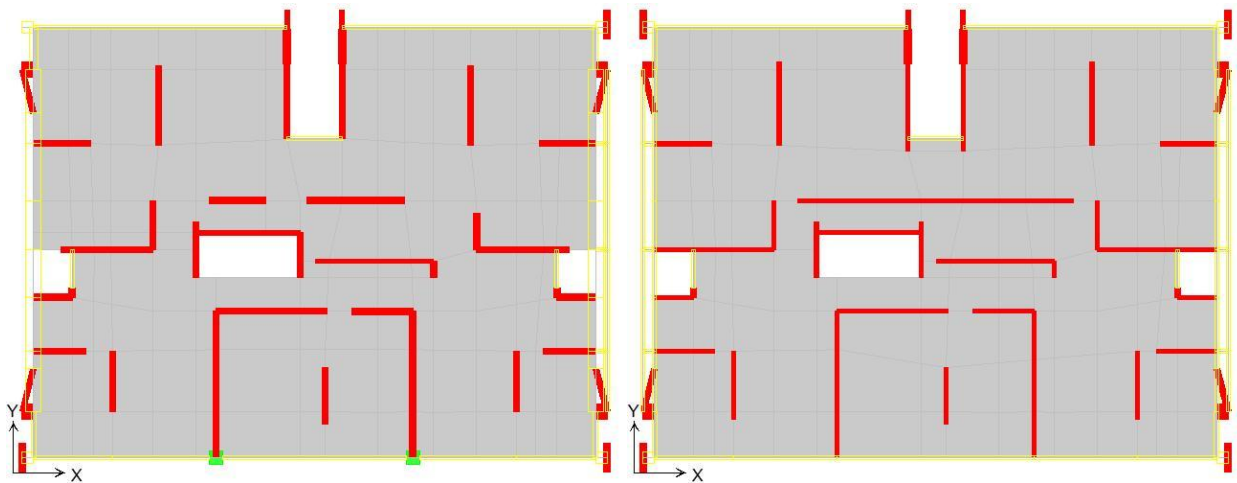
Planta primer piso (izquierda) y piso tipo (derecha) edificio H14
